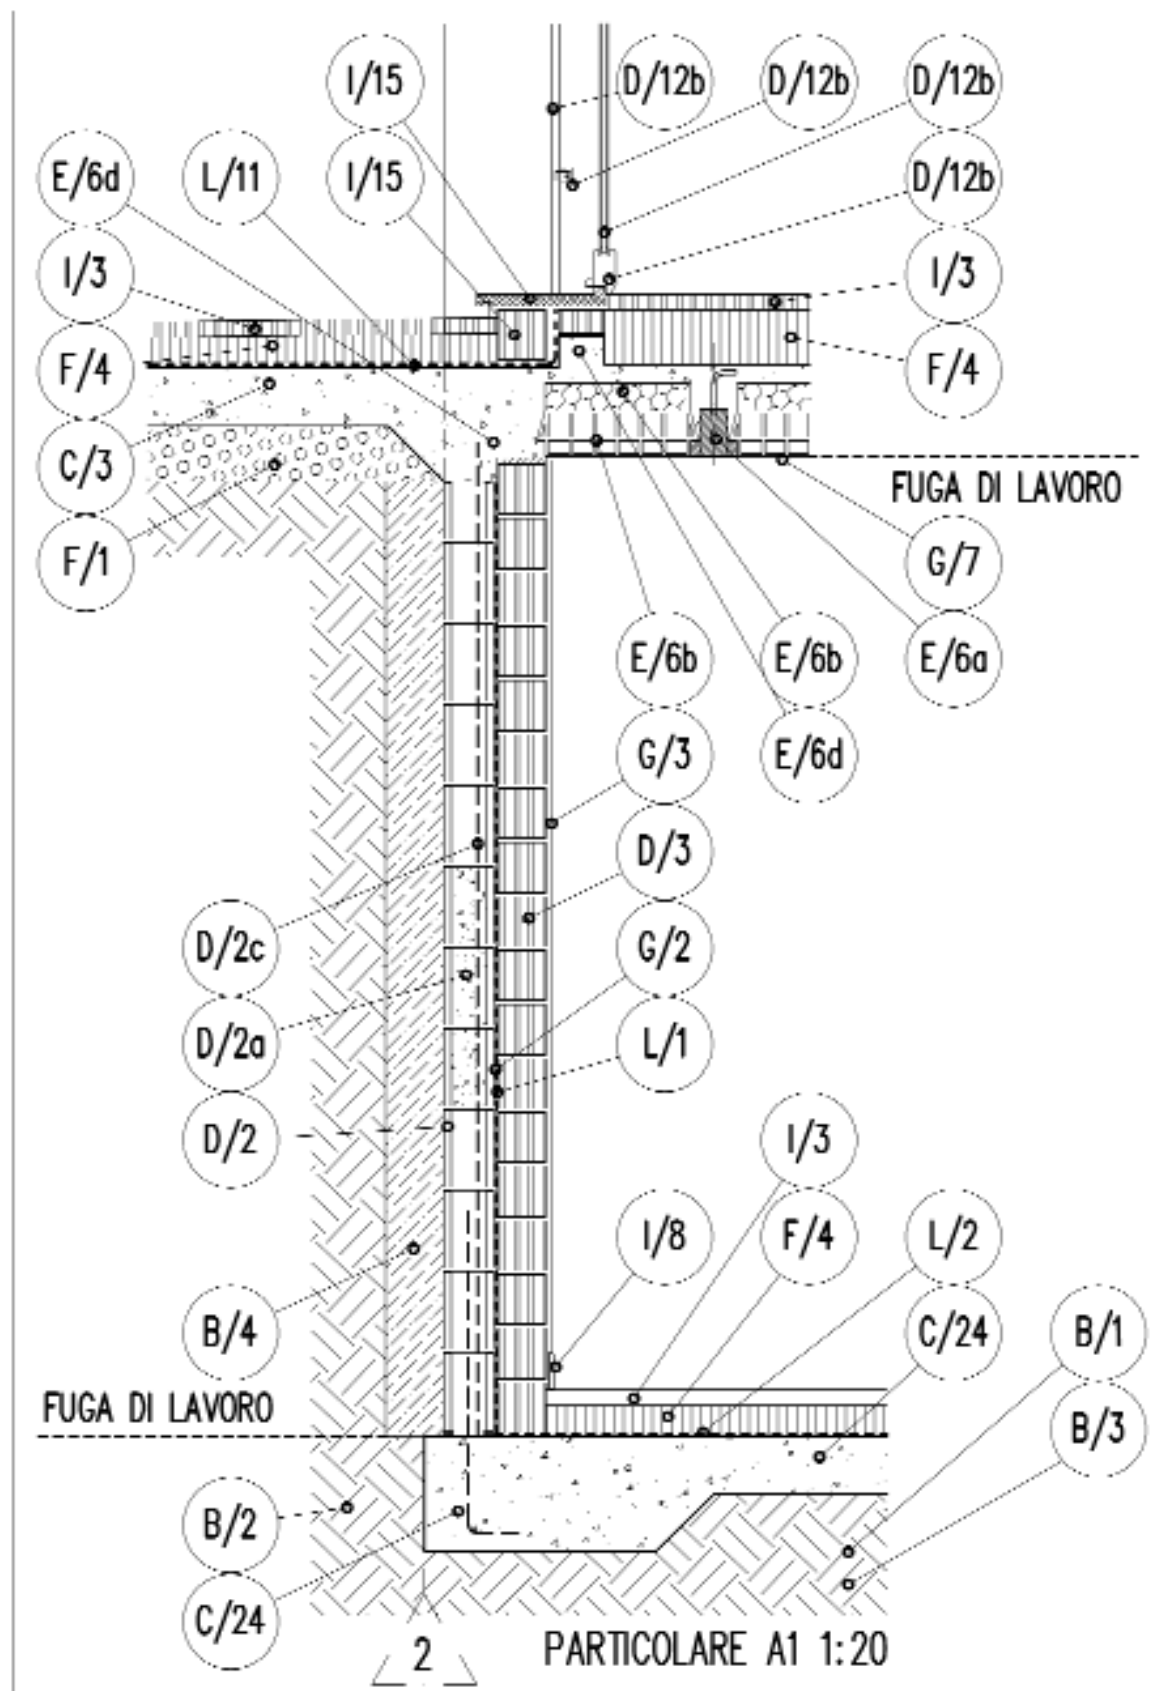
Muro contro-terra. Sezione attraverso apertura al piano terra.
